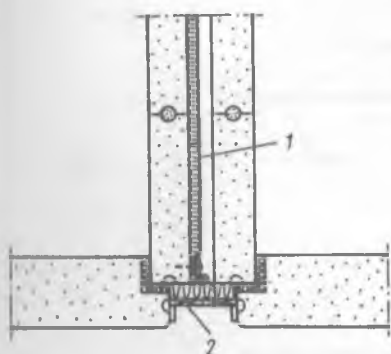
Соединение общей стены с наружной стеной из стандартных плит
